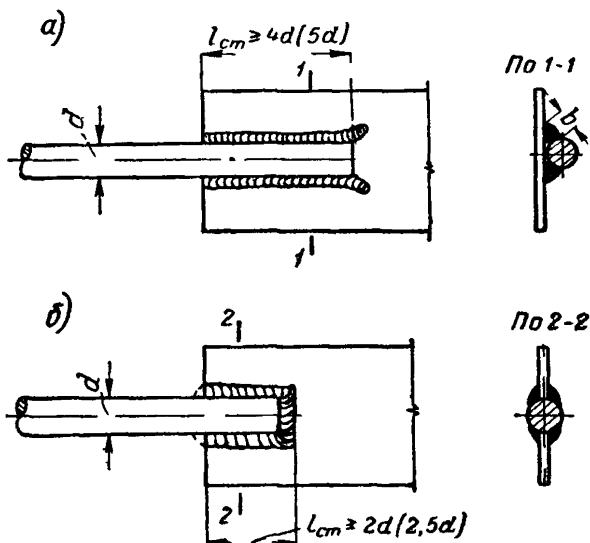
Соединение стержней с закладными деталями внахлестку электродуговой сваркой швом
